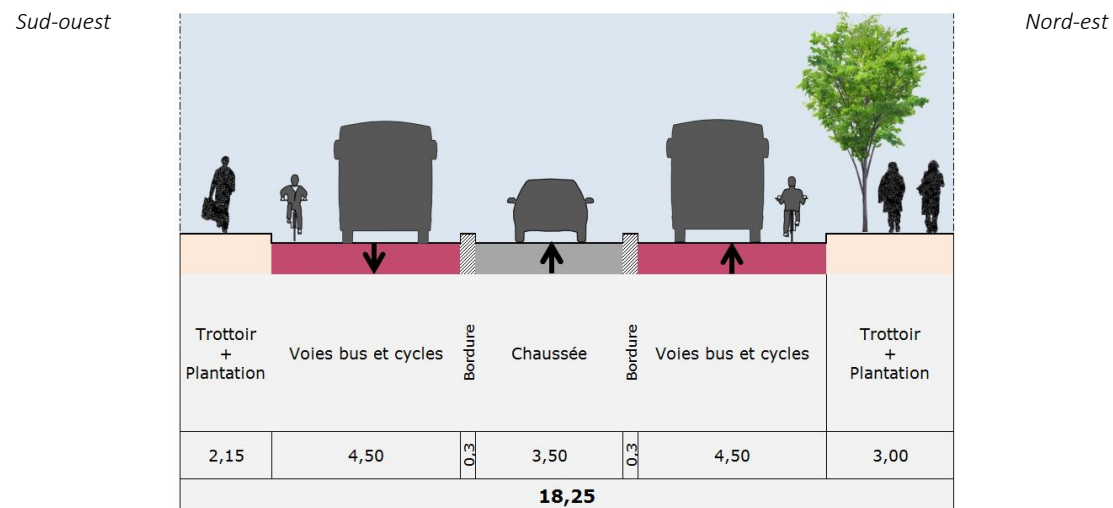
Coupe type sur le boulevard Maurice Berteaux - Variante 2
